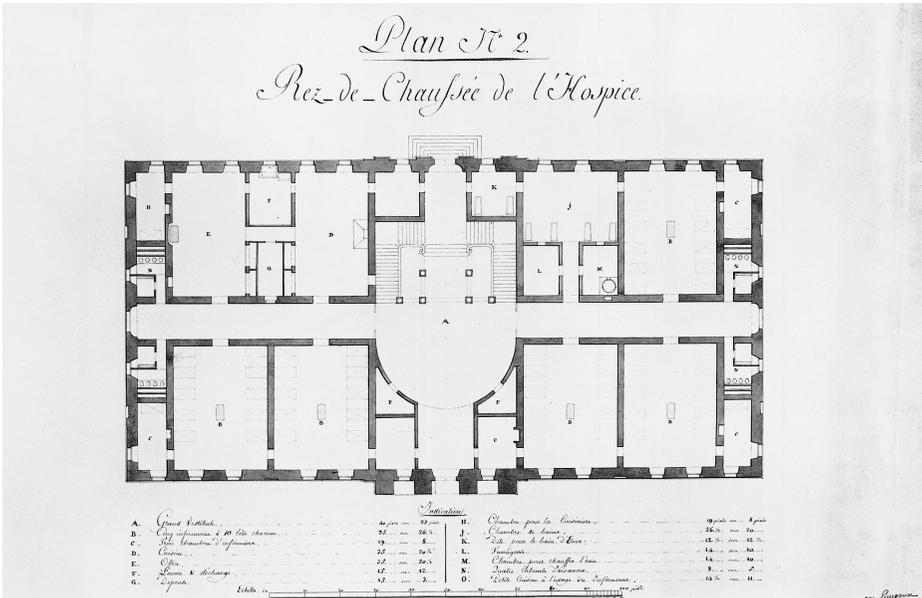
Lausanne, projet d'hôpital par Alexandre et Henri Perregaux, plan du rez-de-chaussée, 1808 (ACV).
